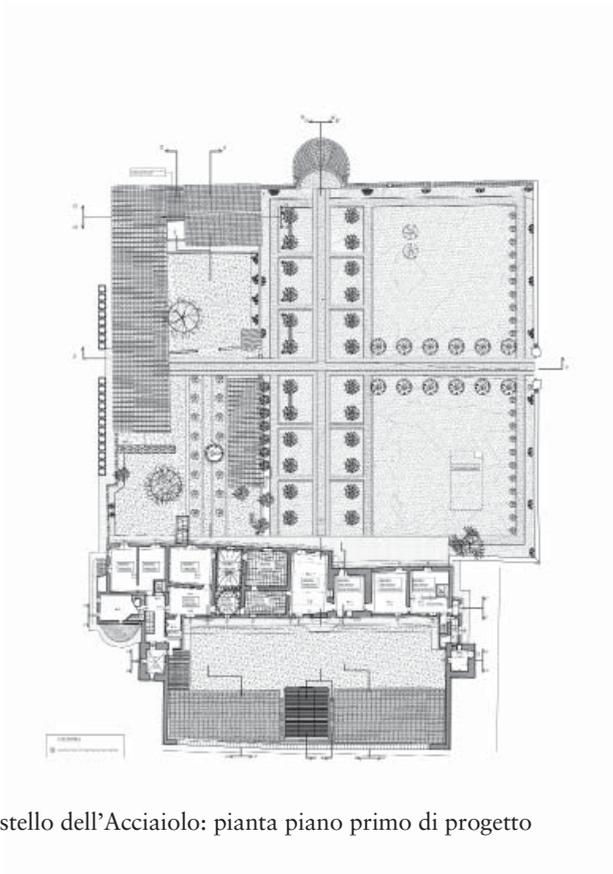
Il castello dell'Acciaiole: pianta piano primo di progetto
